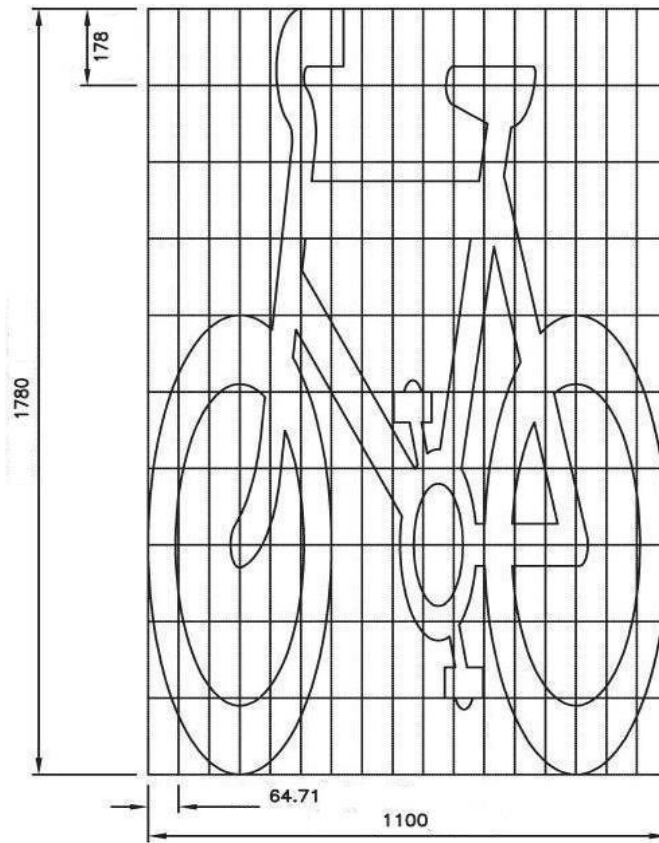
Modelo para sinalização no pavimento de faixas e pistas cicláveis (dimensões em milímetros)
